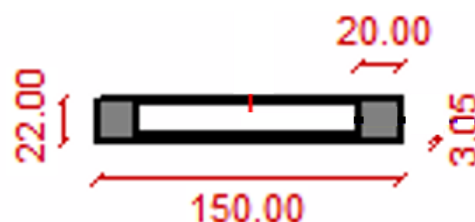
Приведений коробчатий переріз багатопорожнистої плити за
